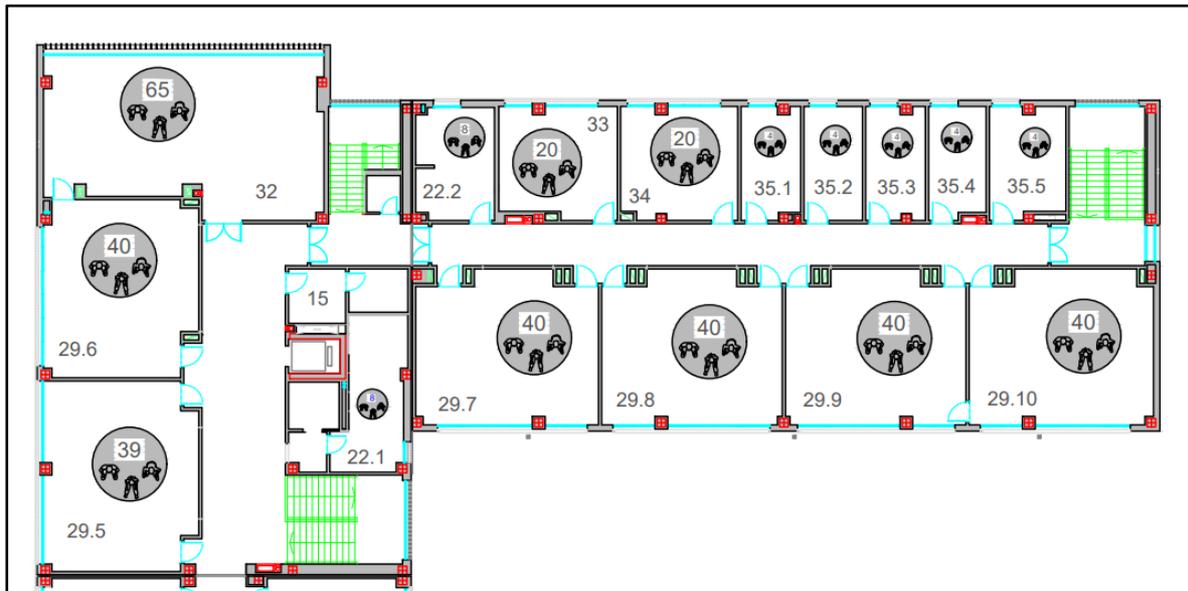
Plano con ocupación por aula de la planta dos – mitad superior
